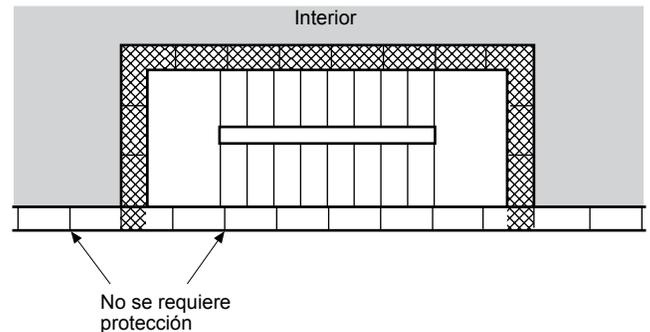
(a) Escalera con muro exterior no certificado en el mismo plano que el del muro exterior del edificio.
